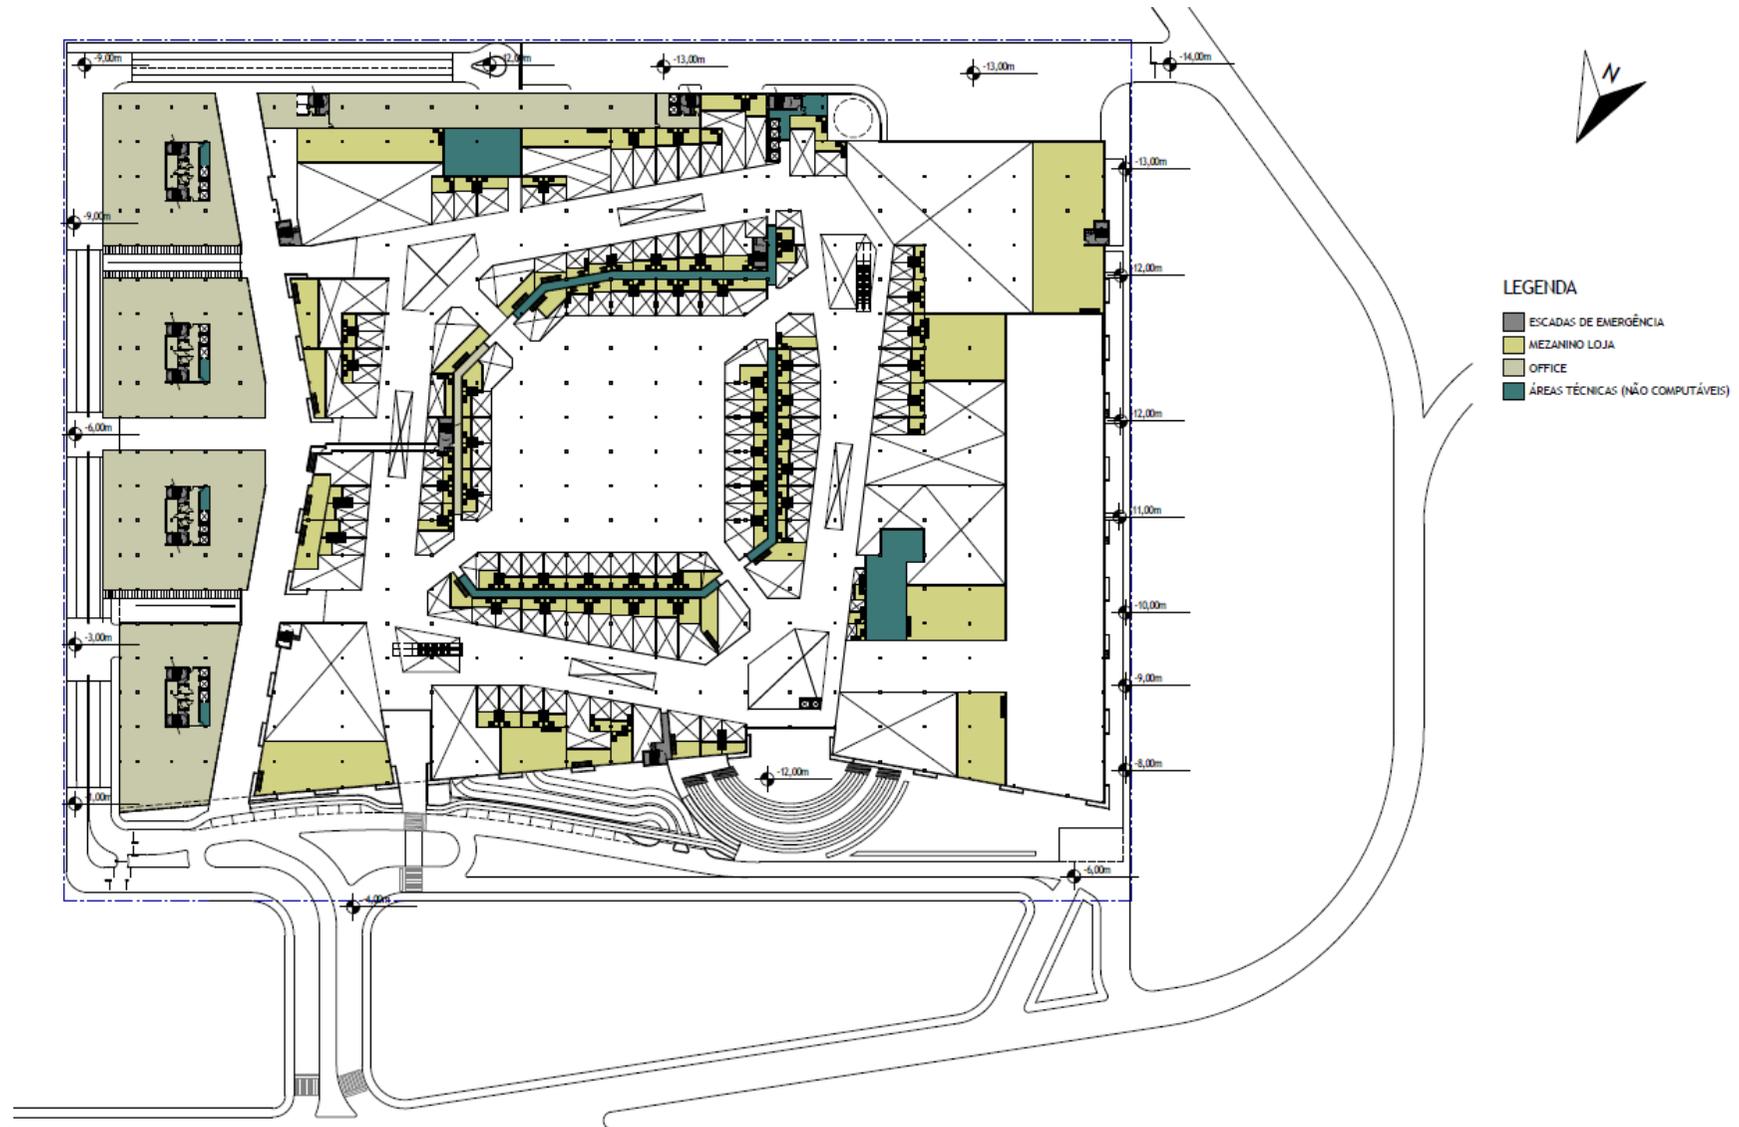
Planta baixa 1 Pavimento, Nível 3,00m
